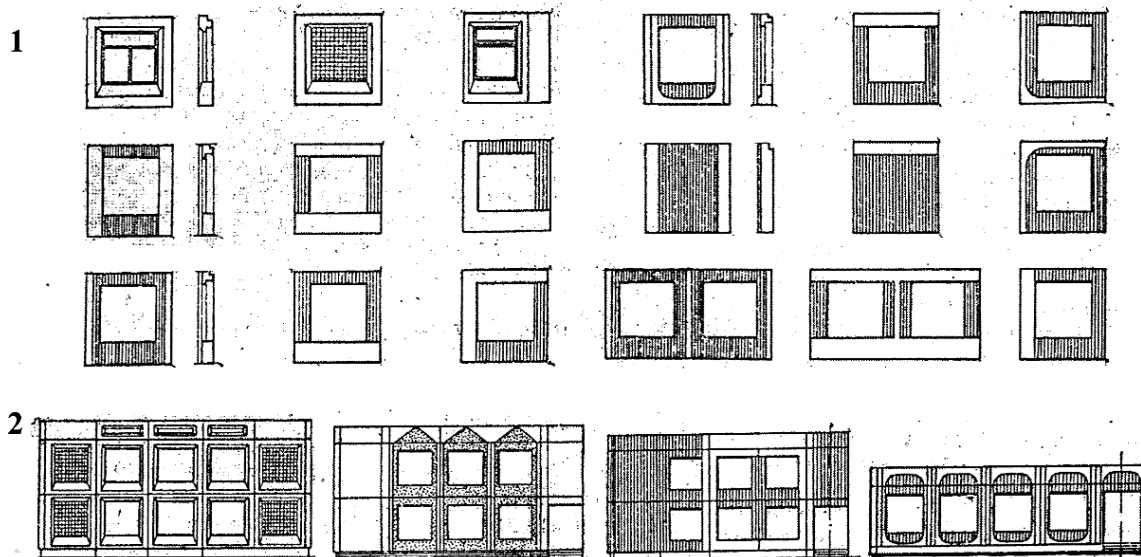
Примеры фасадной отделки панелей наружных стен:
